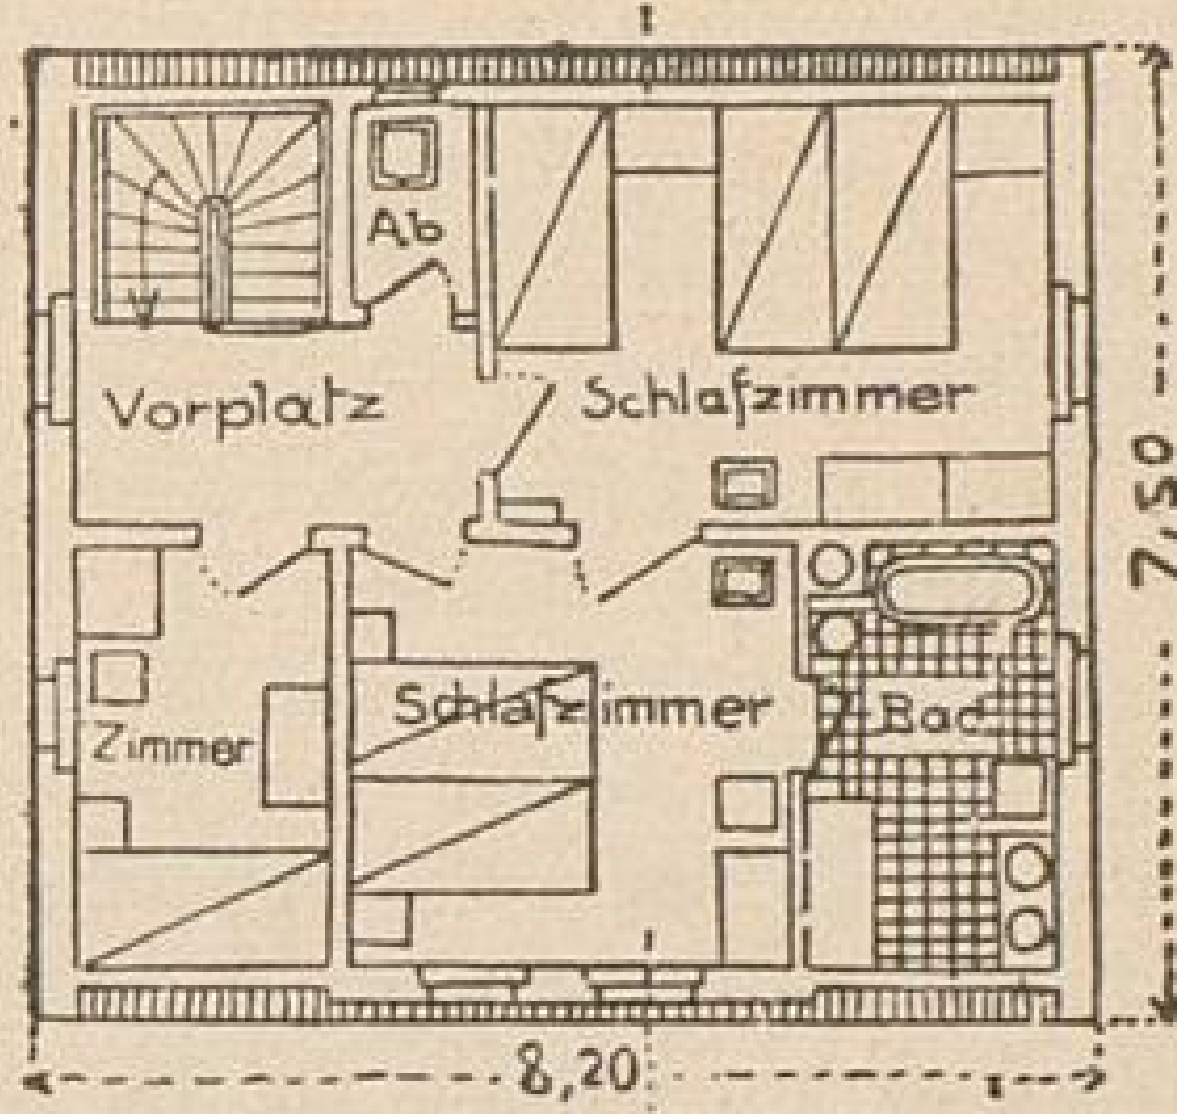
Grundriß des aufgesetzten Dachstockes.
